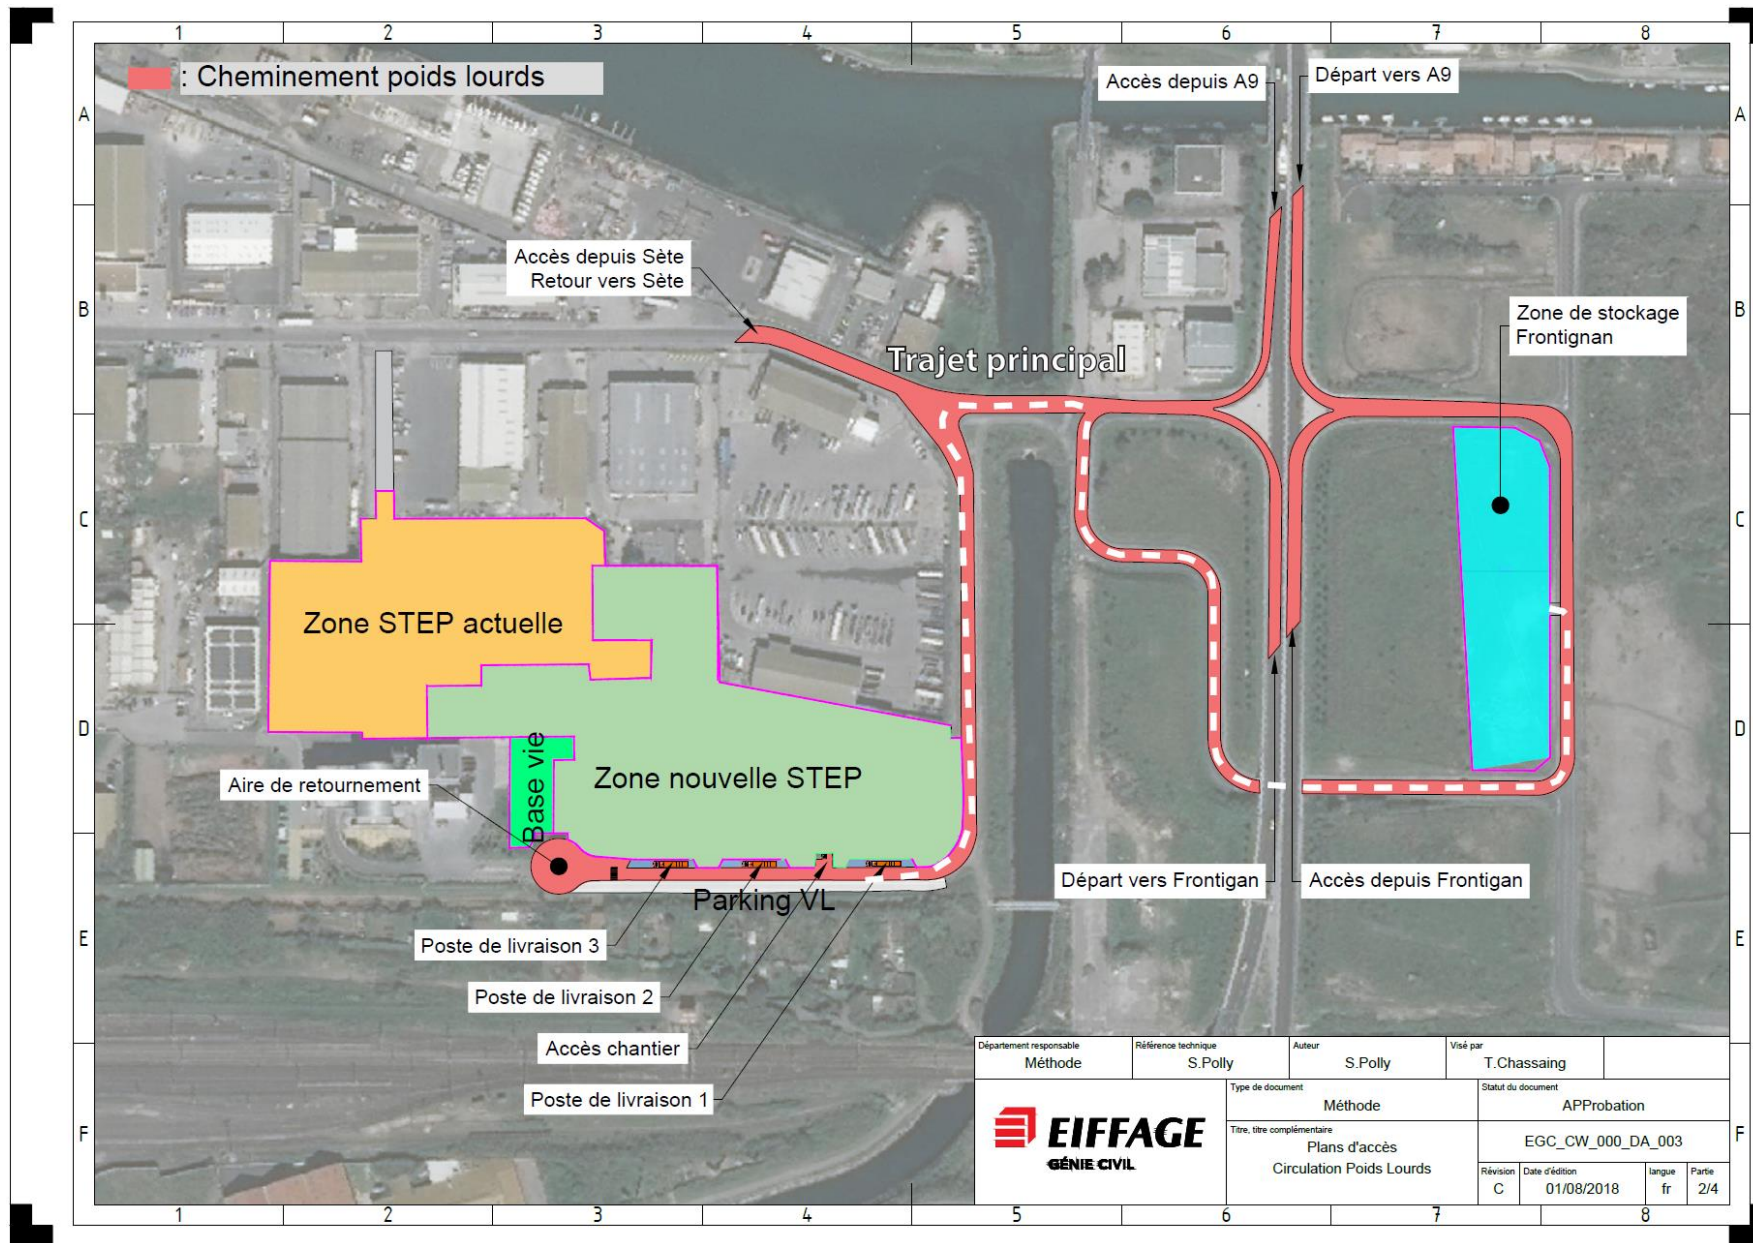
Plan d'accès et itinéraire principal (source : EIFFAGE)
